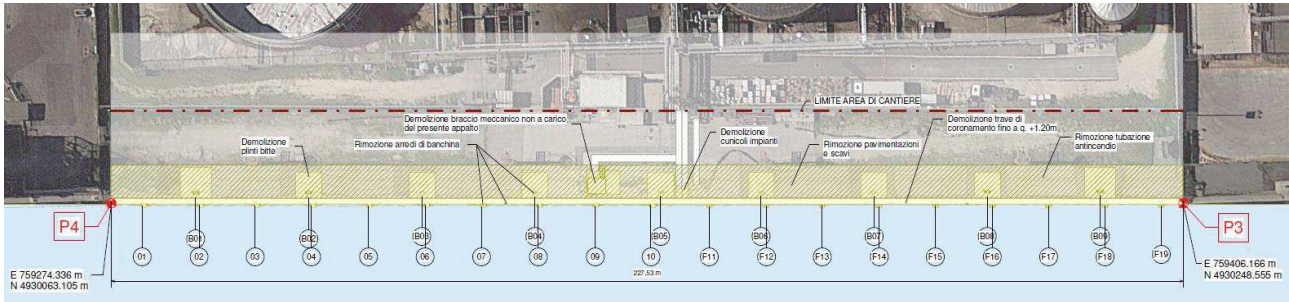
Planimetria generale delle demolizioni e degli scavi.
